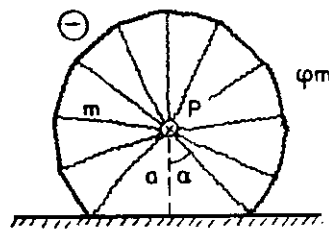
LAJE APOIADA COM ARMADURA SUPERIOR
